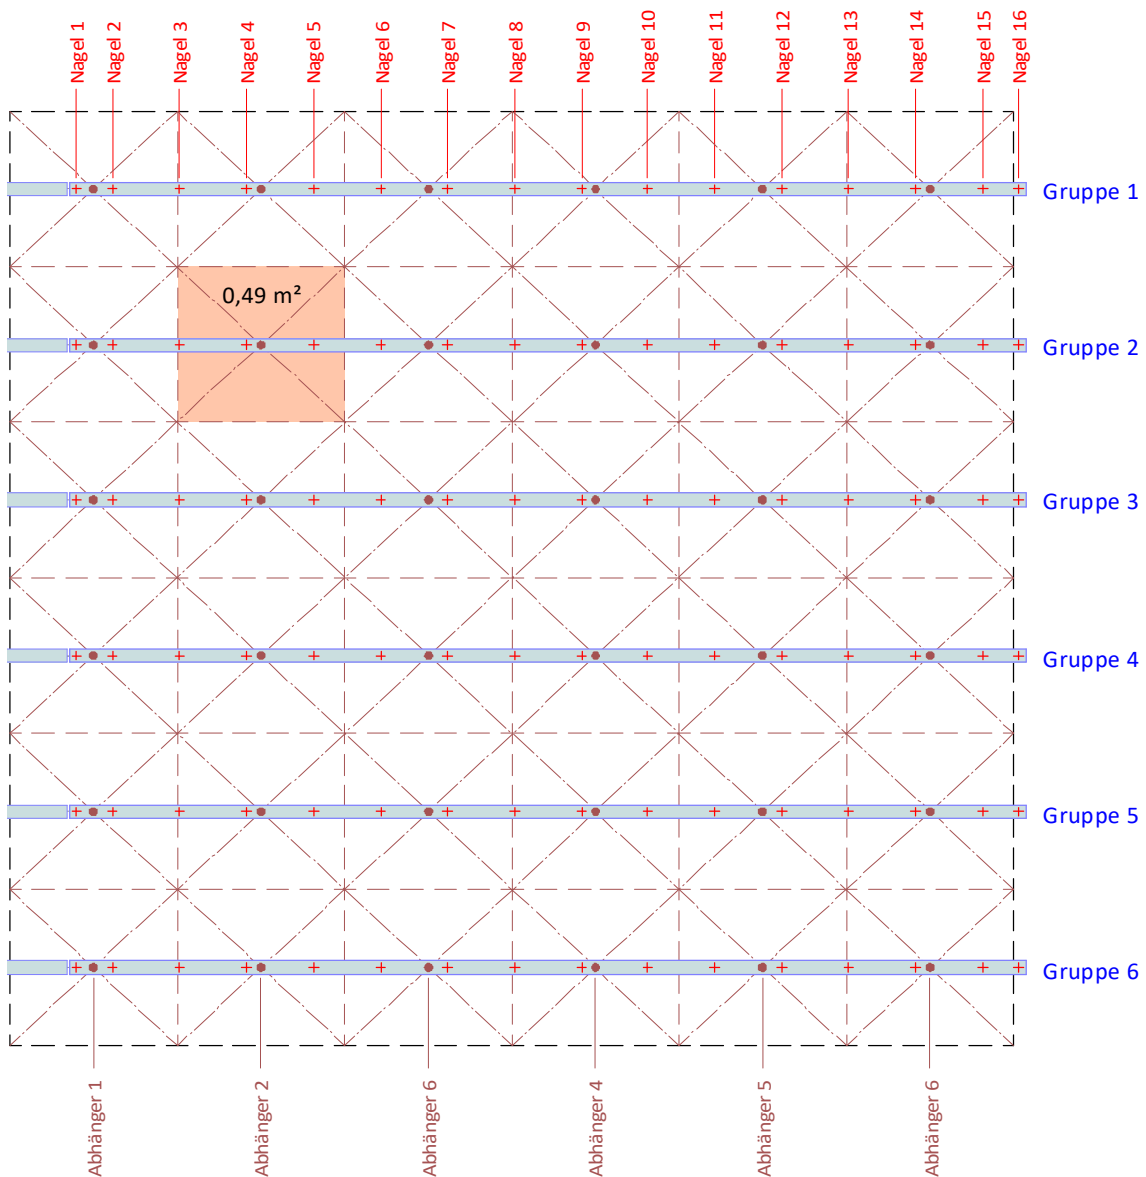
Grundriss Deckensystem mit Nagelabstand 280mm, Quelle: F. Dreier, K. Block
